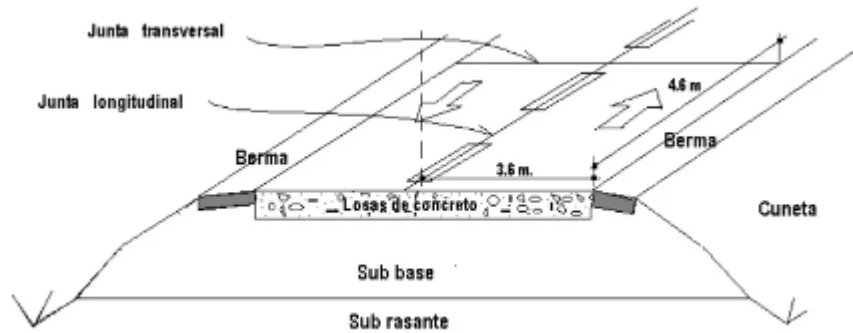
Estructura del pavimento rígido (Martínez, 2020)
